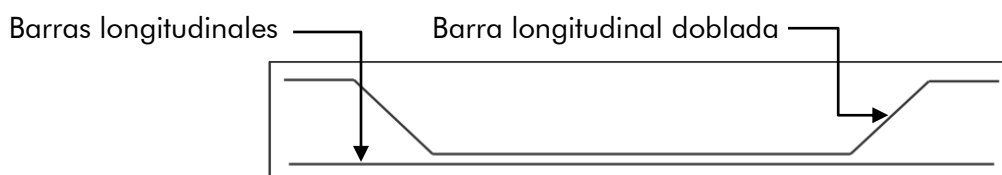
Barras inclinadas dobladas provenientes del armado longitudinal a flexión
